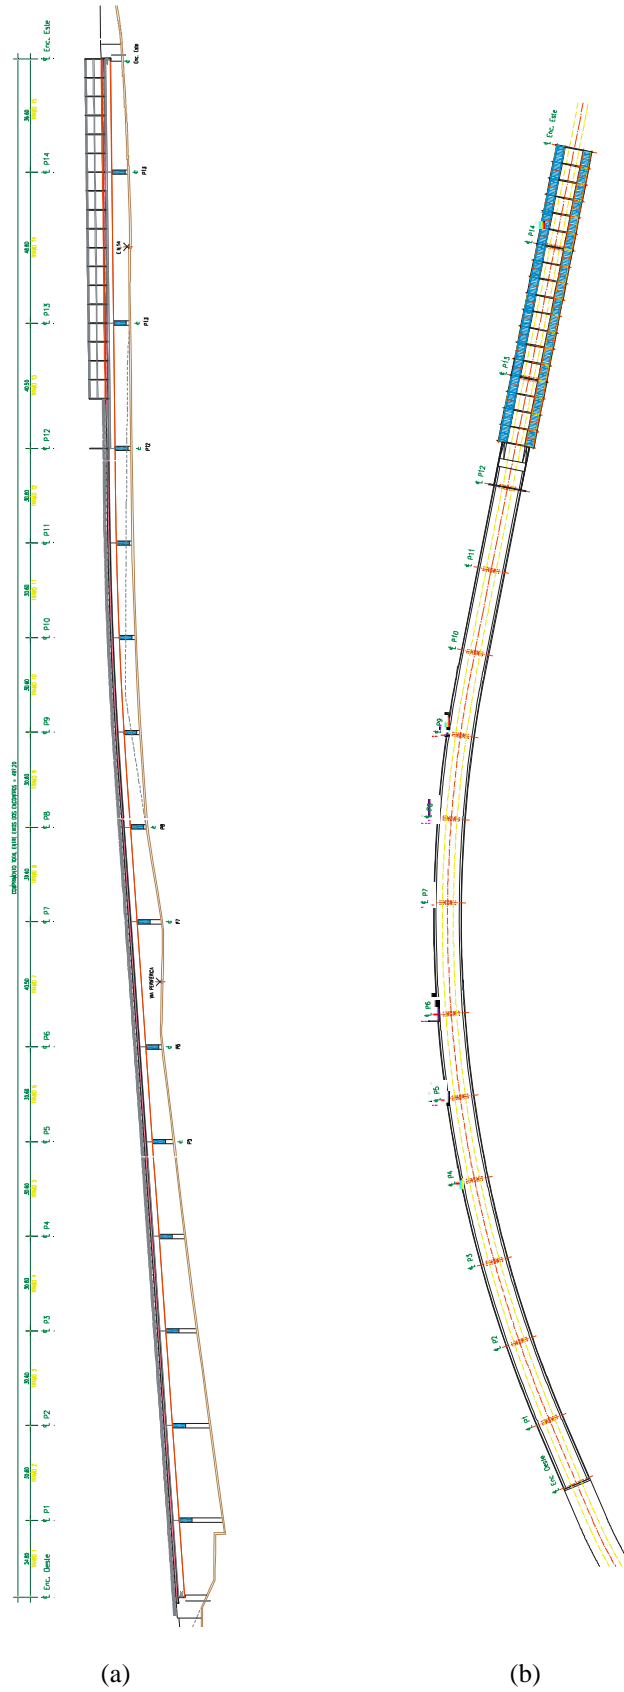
Traçado do viaduto do Parque da Maia: a) rasante; b) em planta.
